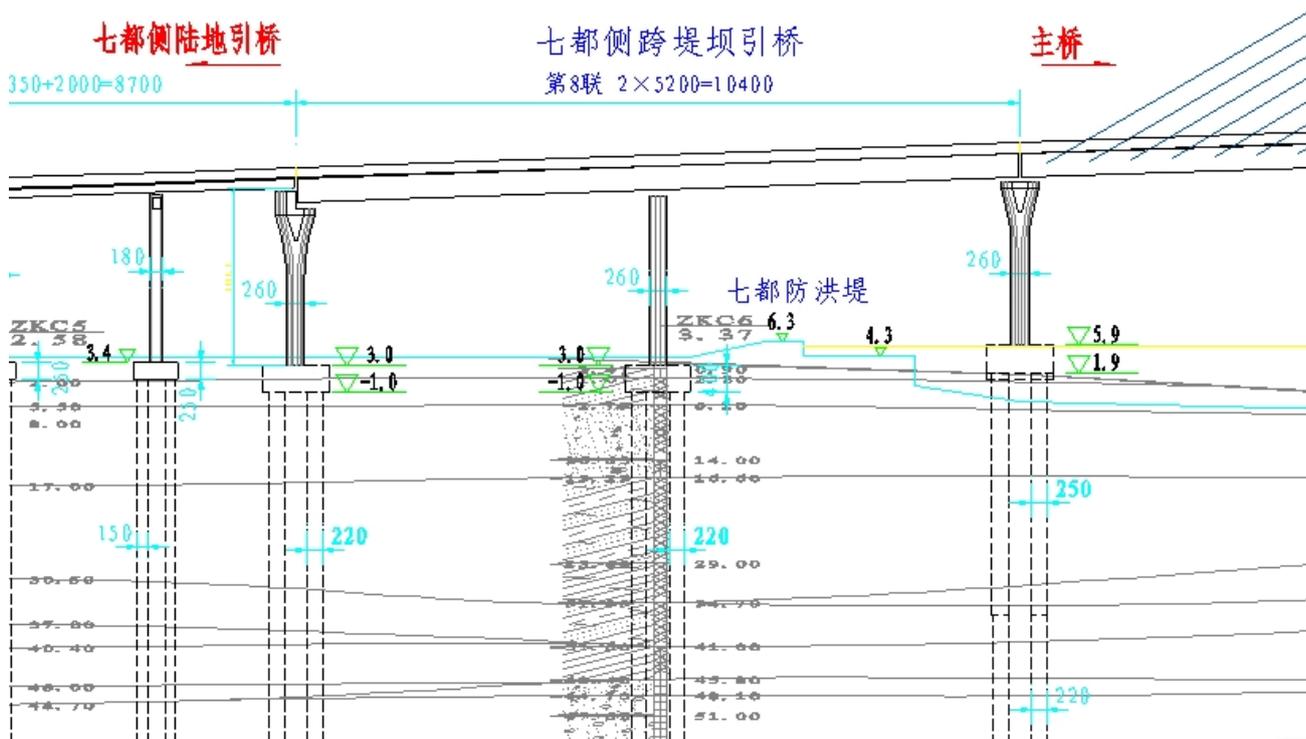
七都侧跨堤坝引桥桥跨布置立面图
